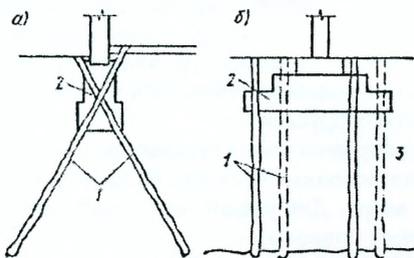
Усиление фундамента сваями, расположенными снаружи здания
